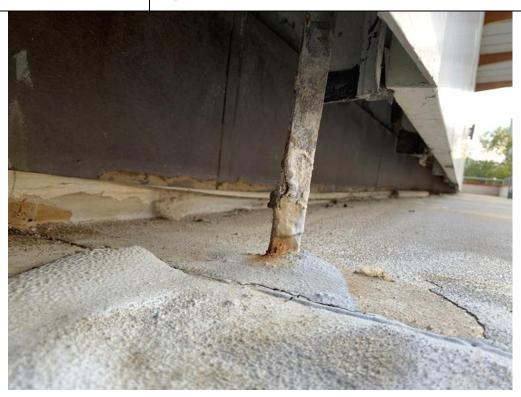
Коррозия металлических элементов вент-фасада, отслоение гидроизоляционного слоя
